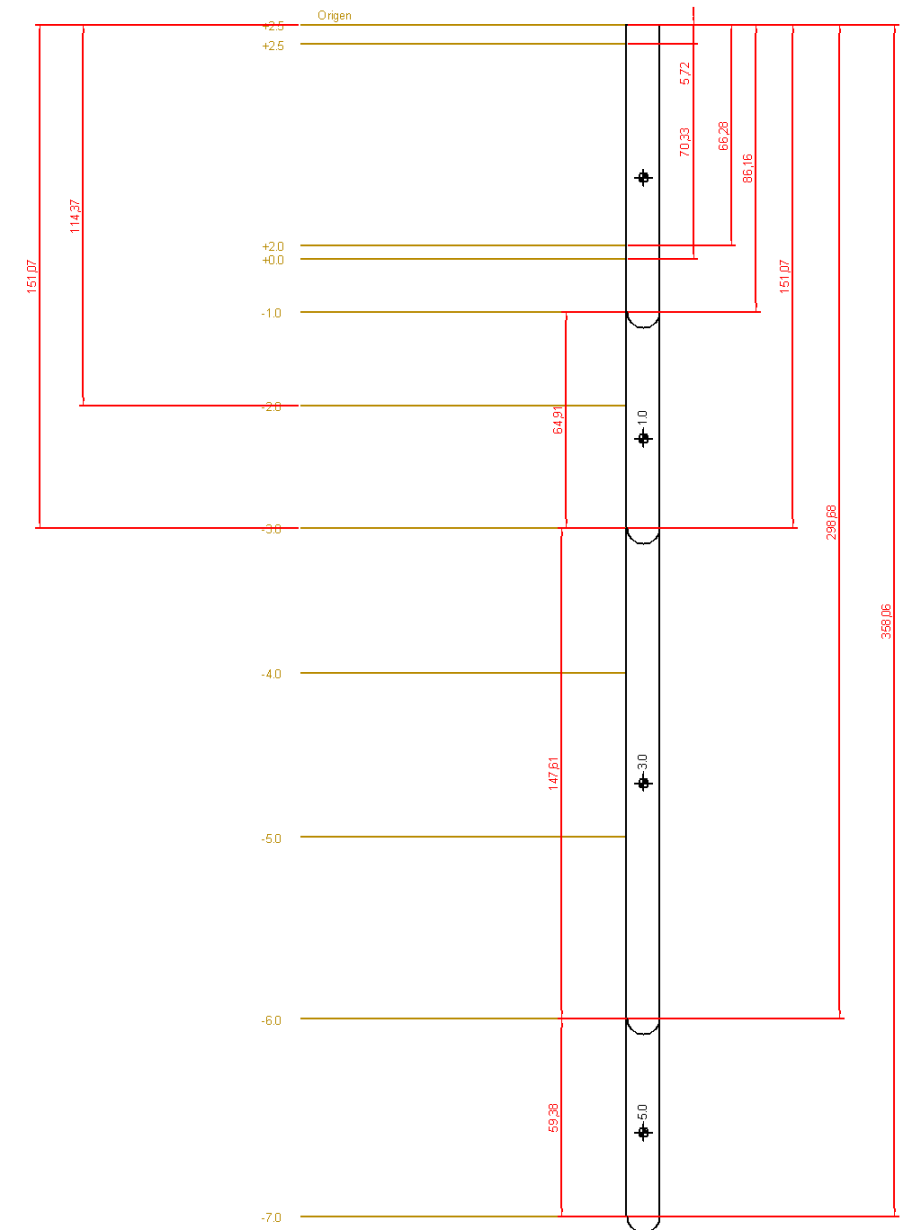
Esquema del espigón norte con relación a las líneas de nivel del perfil tipo de aporte
